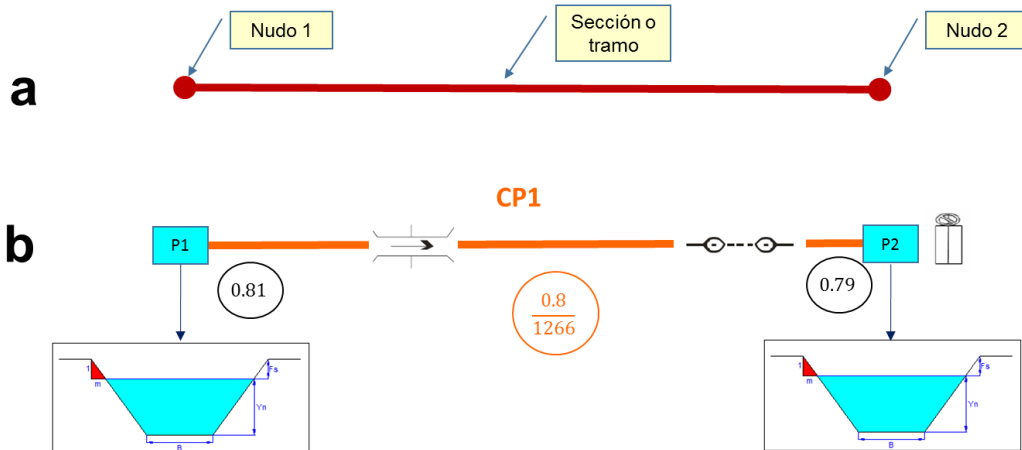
Tramo de un canal: a) esquema general; b) croquis detallado.
